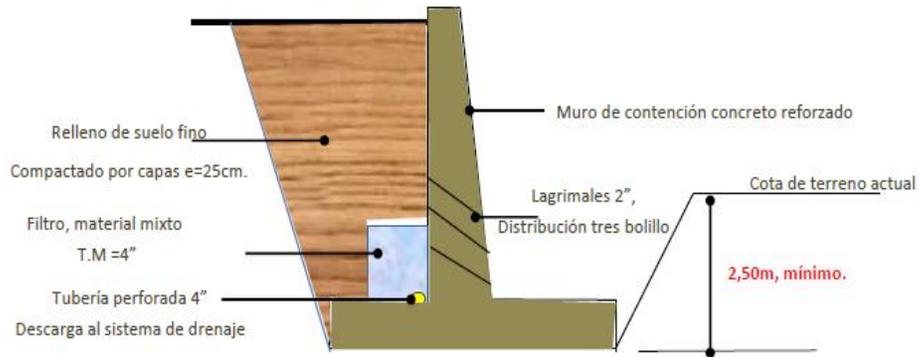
Propuesta de cimentación, muro convencional concreto reforzado
